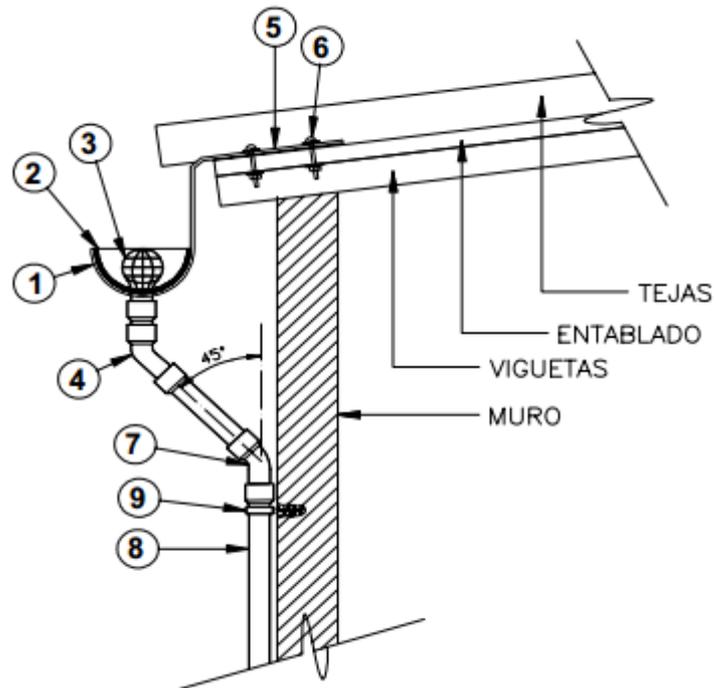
Detalle de colocación canal y bajante pluvial
